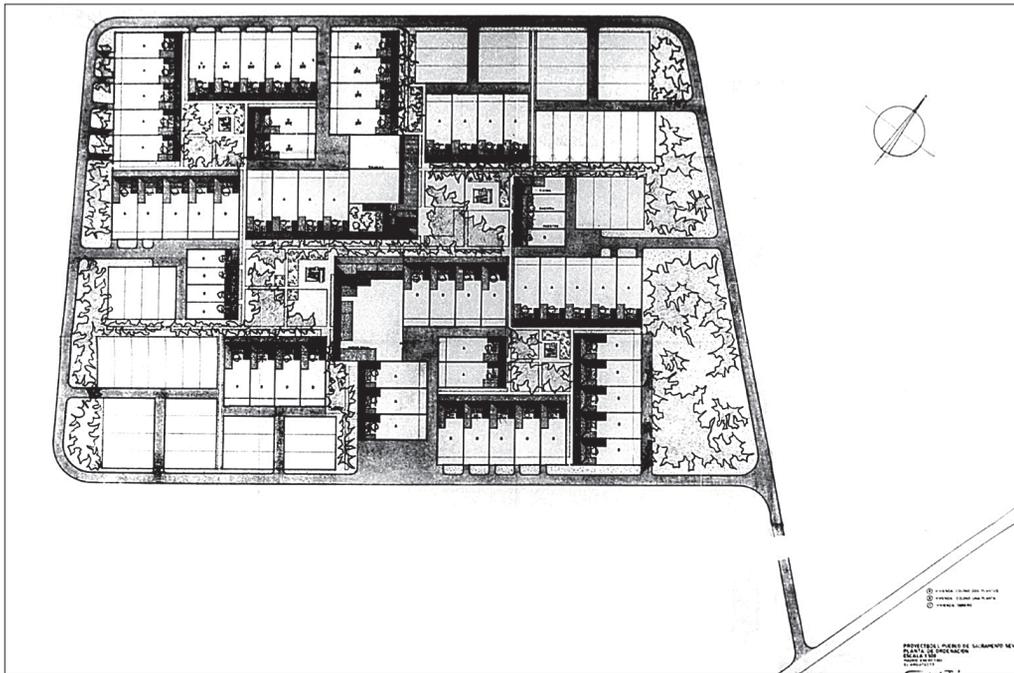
Planta de Sacramento, Sevilla (Fernando de Terán, 1965).
